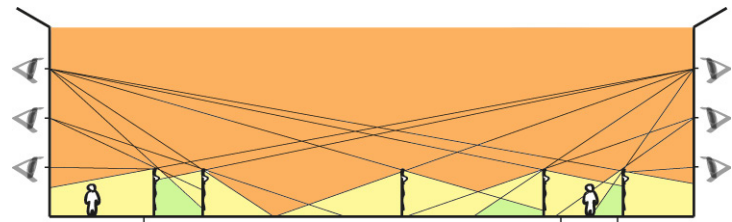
Plank med placering centrerat på gården. Den enkelexponerade zonen fördelar sig lika på båda sidorna om planket, från plankets överkant mot marken.
